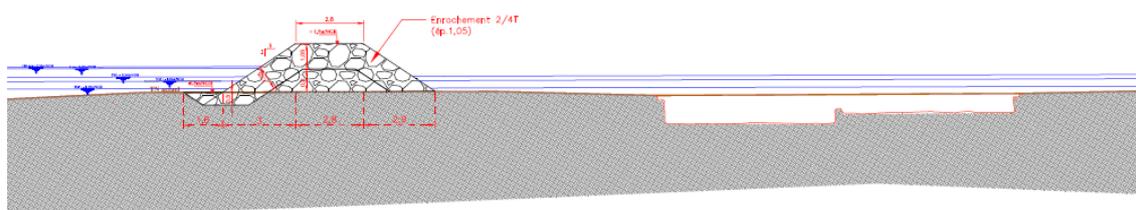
Vue en coupe de la fosse d'apprentissage de la baignade
